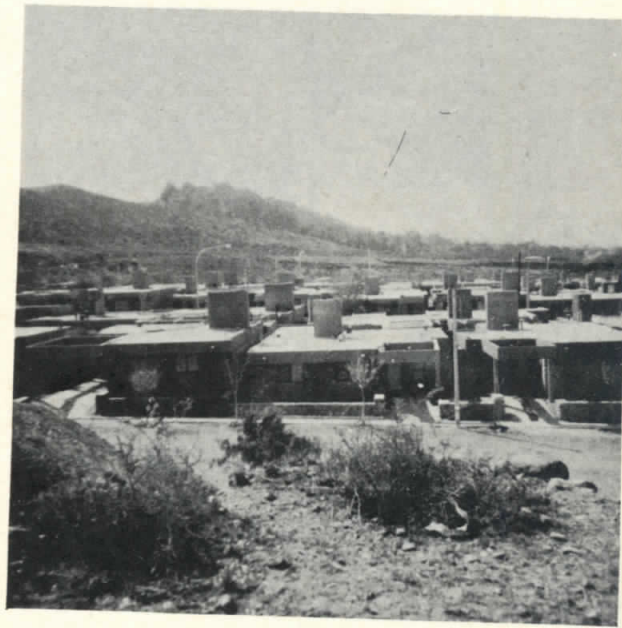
Sector en evidente estado de deterioro en Pedro Molina, Guaymallén.
